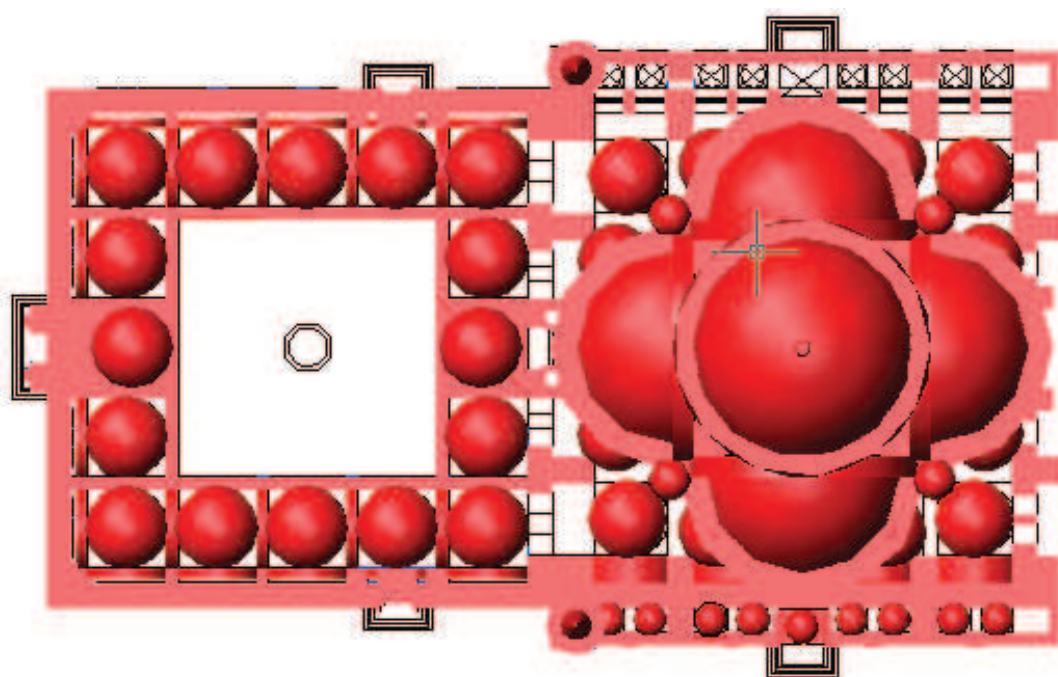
Estructura general del sistema de cúpulas en vista superior. (Constr. 3D del autor).
